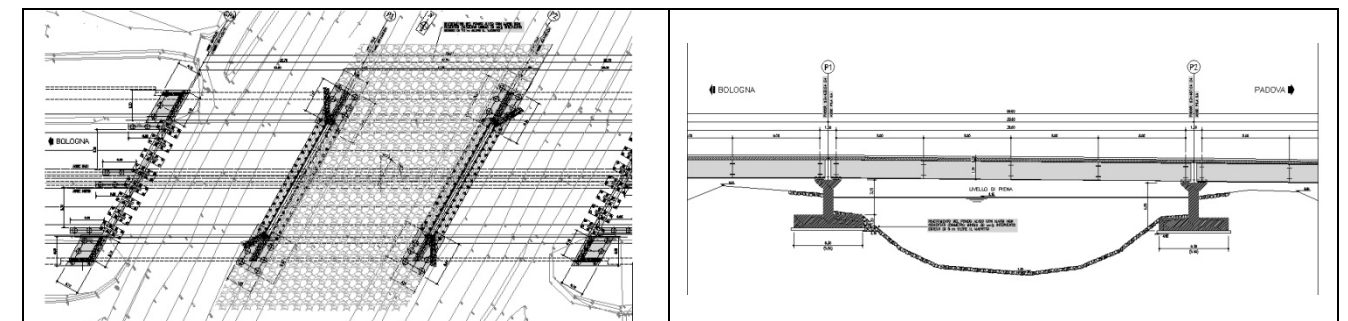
Canale Vigenzone planimetria e sezione longitudinale
